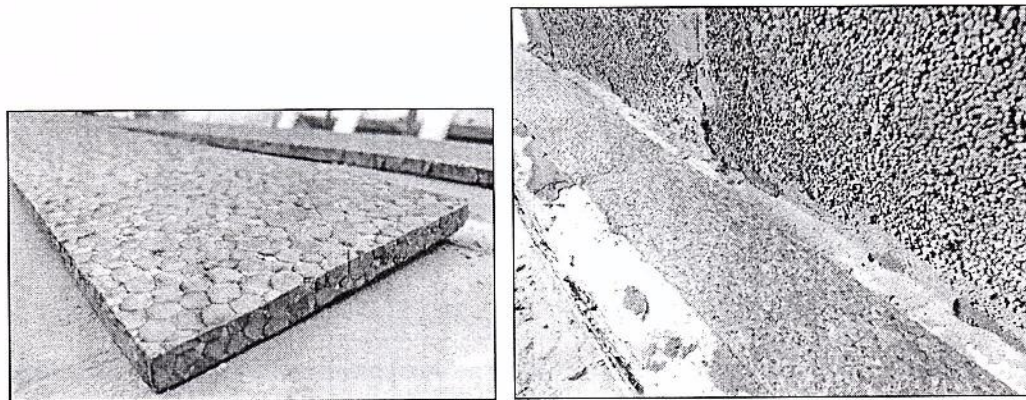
Detalle constructivo del panel WSG 75 (aportado por el peticionario)
